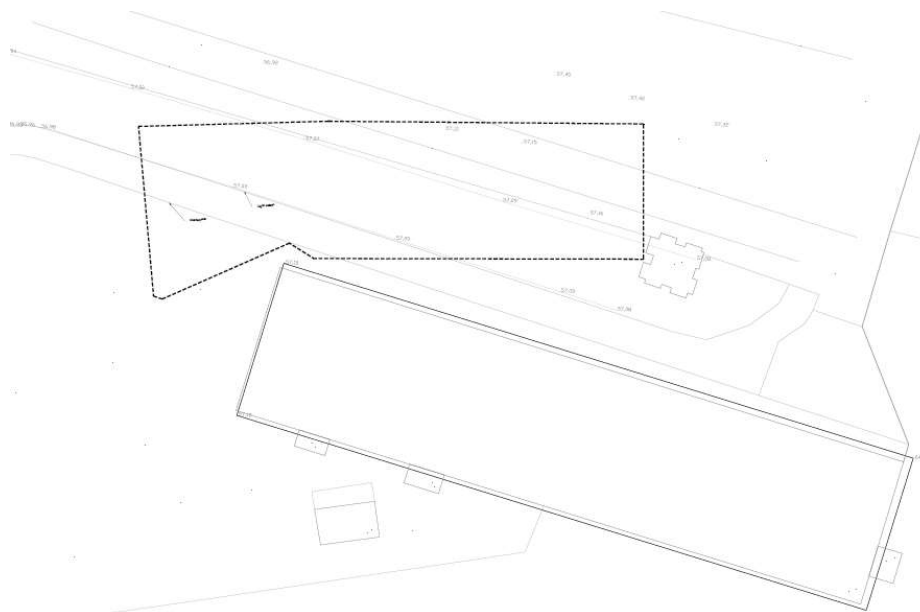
Estratto planimetrico dello stato di fatto – Individuazione dell'area oggetto di intervento con polilinea nera tratteggiata.
